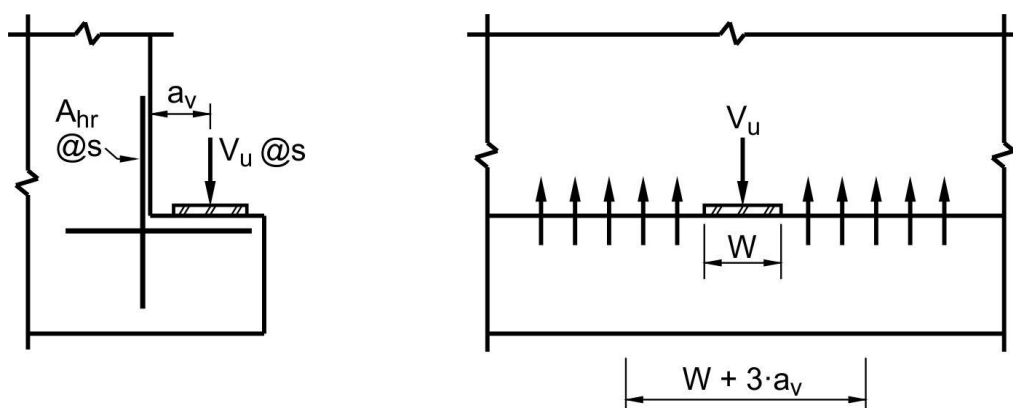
Armadura de suspensión en un único resalto horizontal
